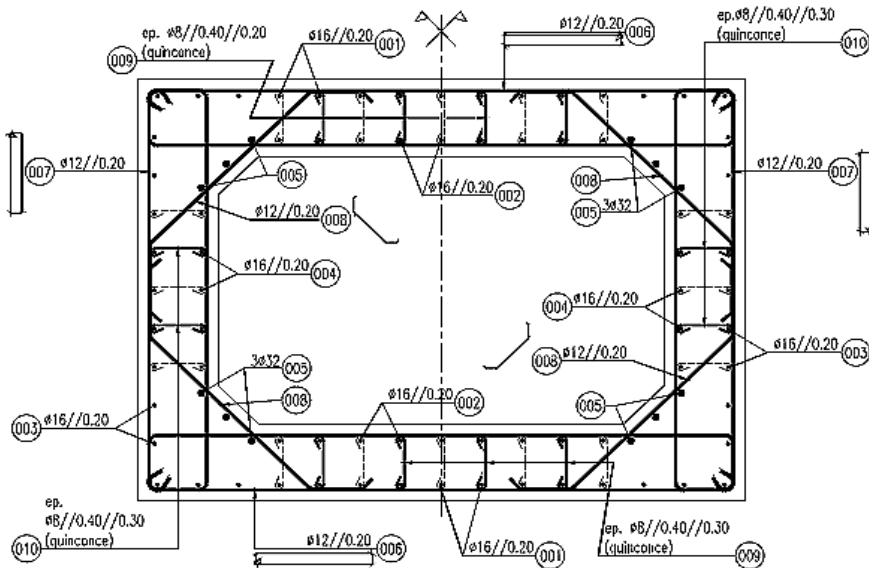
Le ferrailage longitudinal et transversal au milieu de fût des piles courtes
